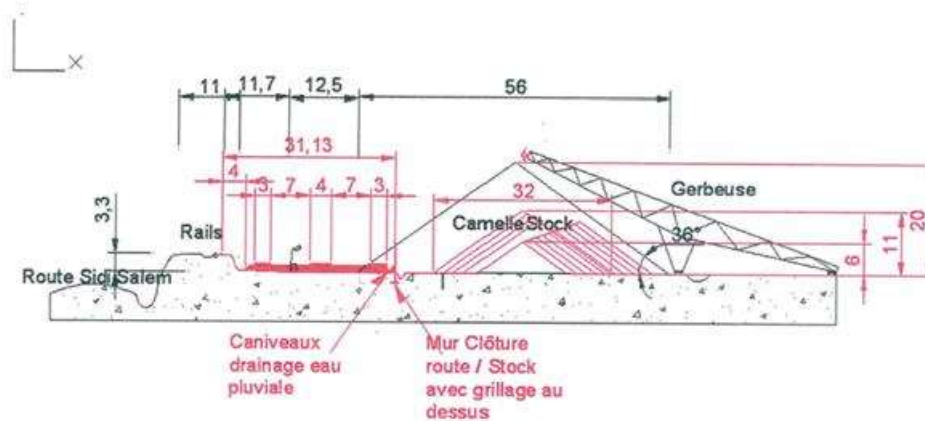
VUE EN PLAN DE L'AIR DE STOKAGE FUTUR PAR RAPPORT A L'EMPRISE PNS
